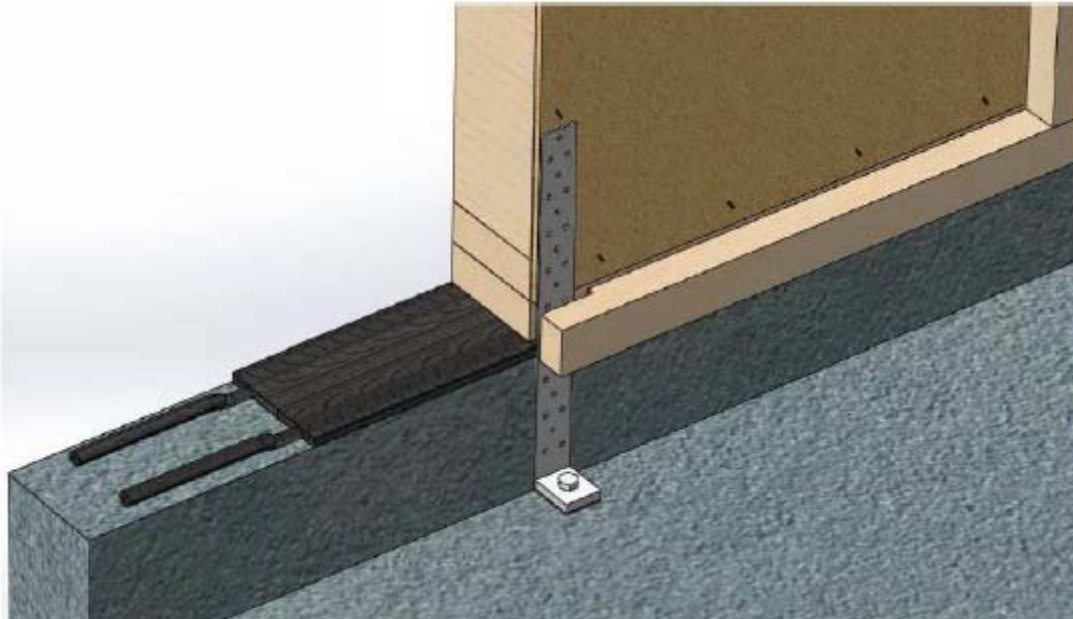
Détail de de l'entaille nécessaire sur les tasseaux bas au droit des ancrages
